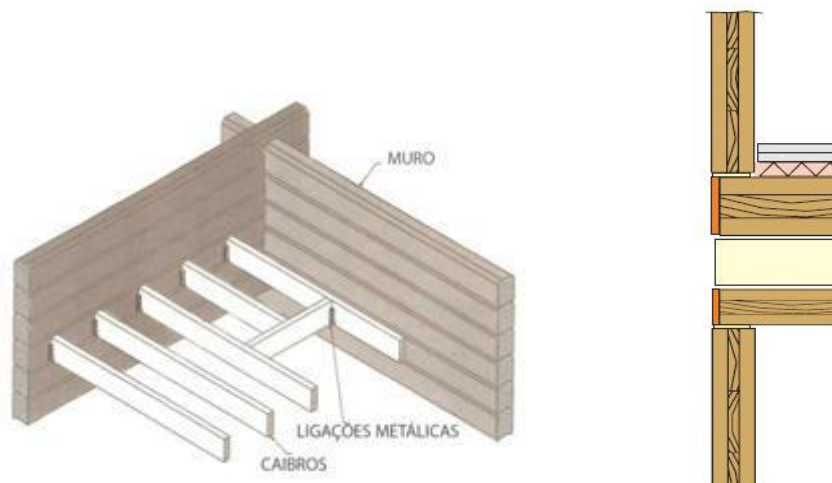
Ligação dos pavimentos à fachada [2] [22]
